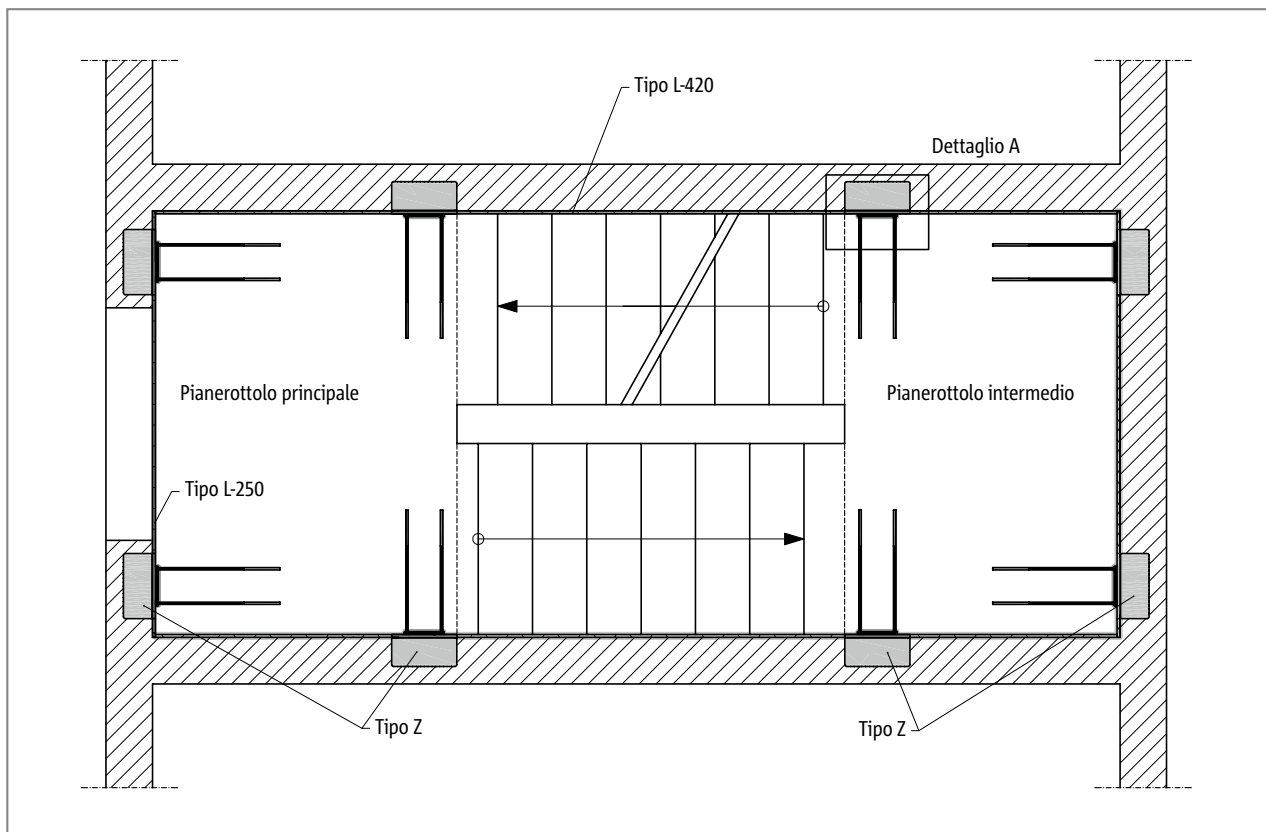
Schöck Tronsole® tipo Z, disposizione alternativa dell'elemento nella pianta
